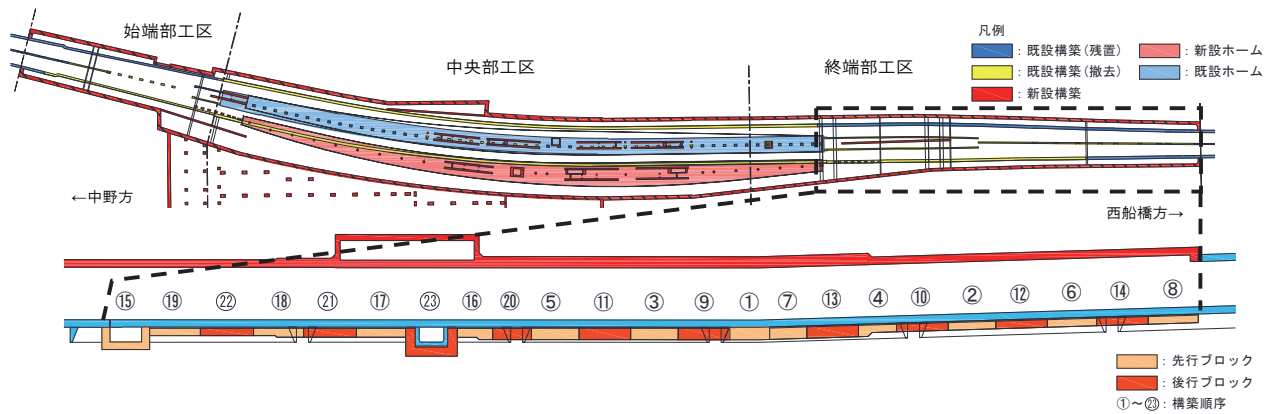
全体平面図および新設下床版打設ブロック割縦断面図
